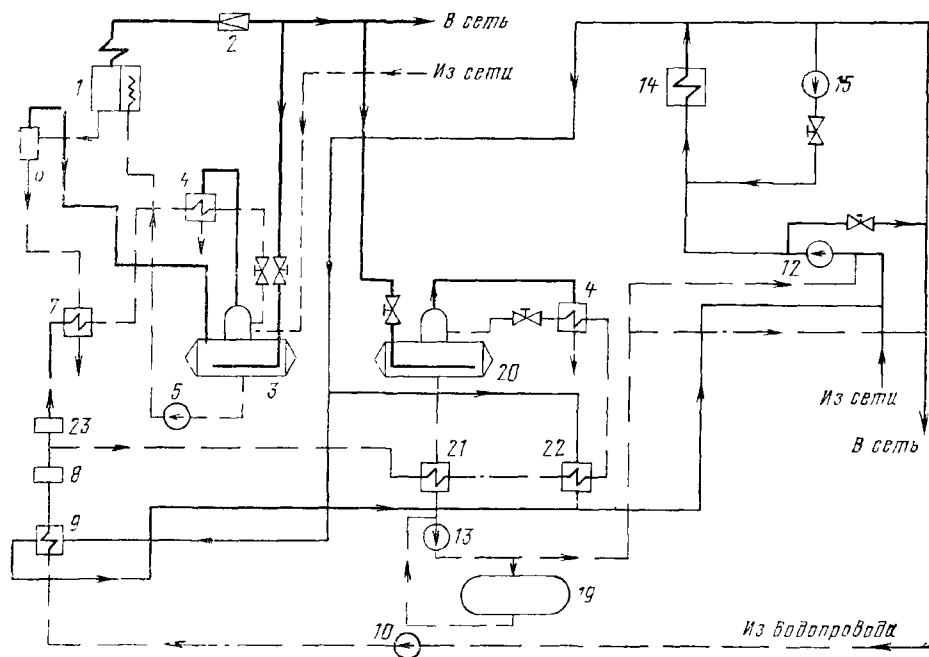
Принципиальная схема промышленно-отопительной пароводогрейной котельной с отпуском тепла при открытой системе теплоснабжения
